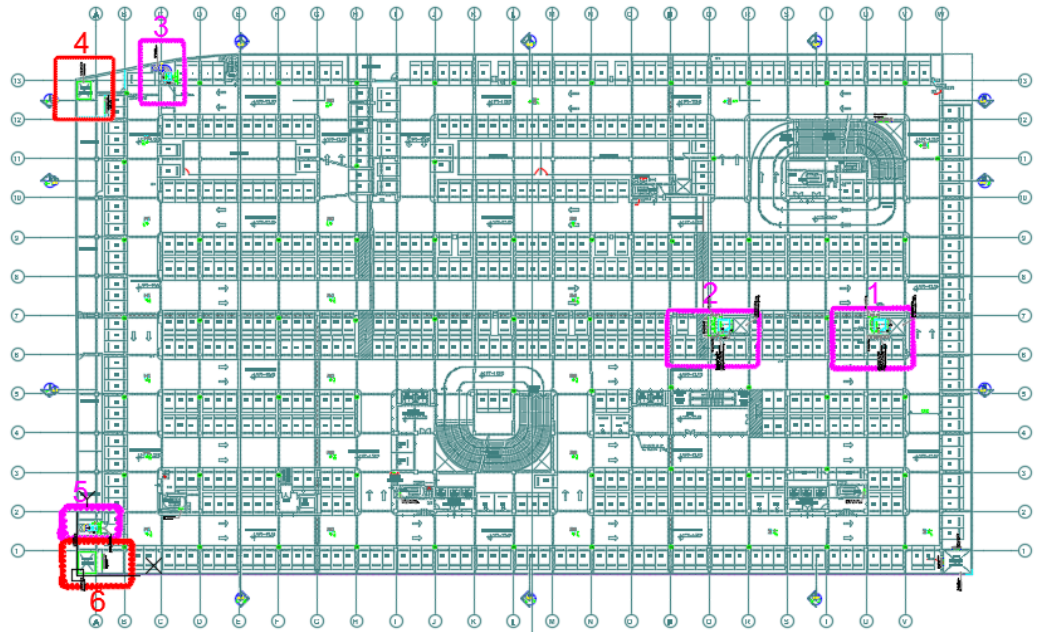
PLANTA GENERAL TÍPICA DEL 5º SÓTANO AL 3º SÓTANO
